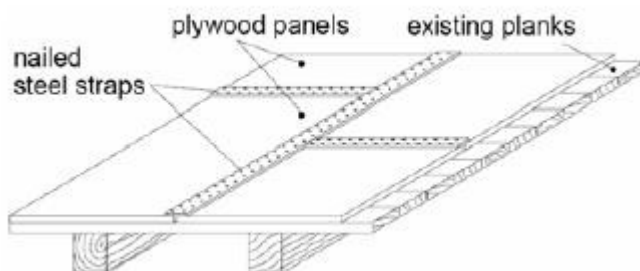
Aplicação de painéis de derivados de madeira sobre soalho existente (Marini et al.;2006).
